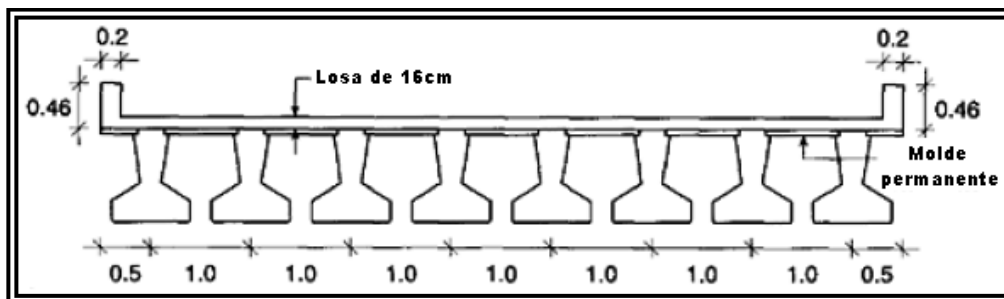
169 Tablero de puente tipo viga-losa.¹⁸³
